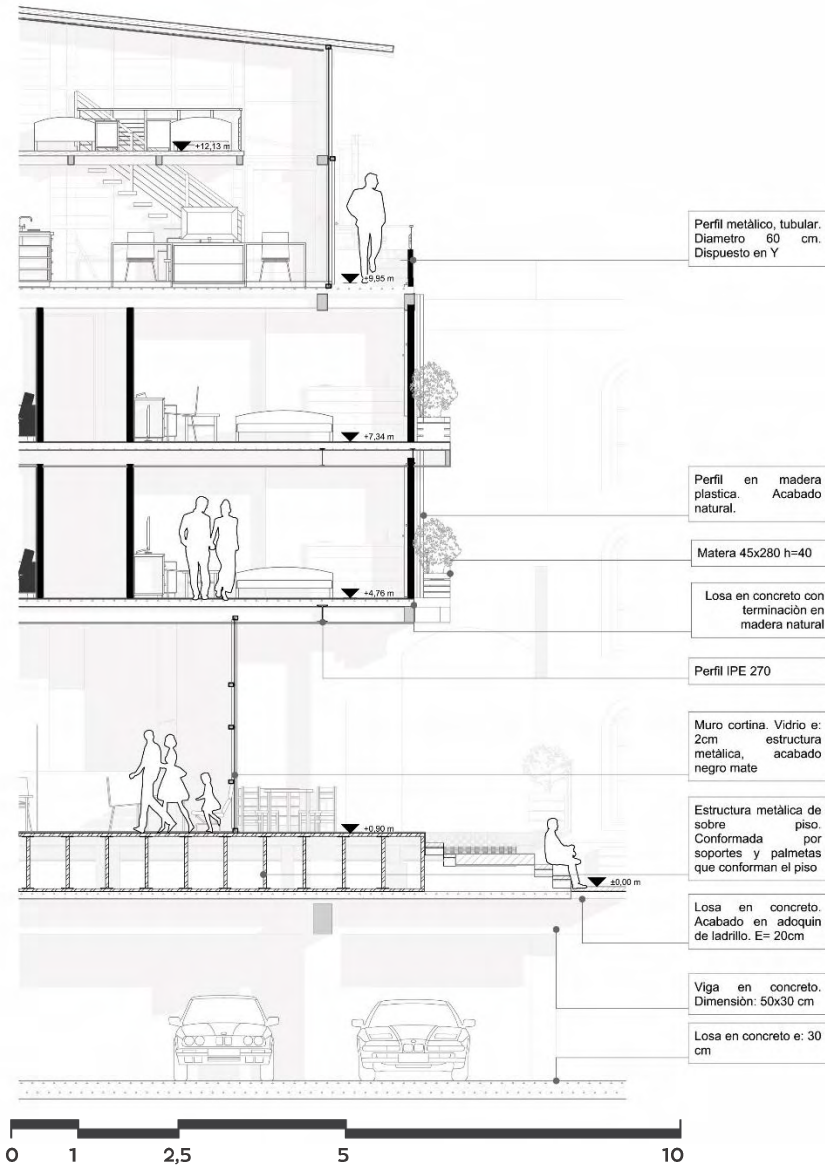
Corte por fachada Bloque alojamiento. Fuente: Elaboración Propia.
